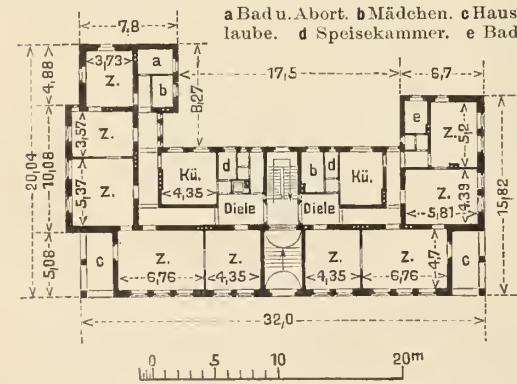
Erdgeschoß des Beamtenwohnhauses.
